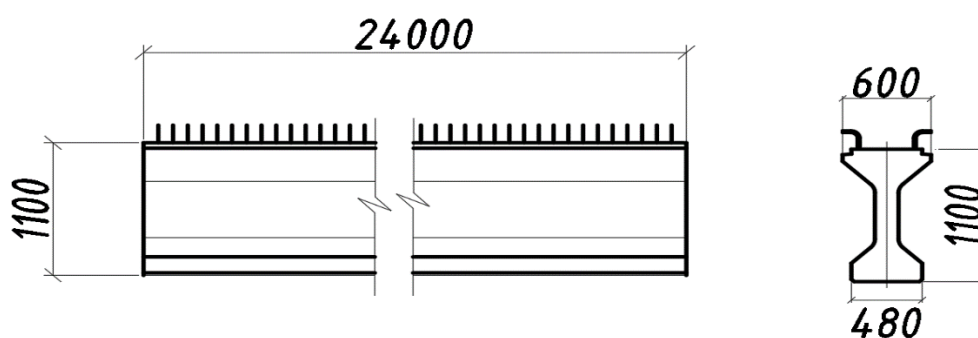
Попередньо напружена залізобетонна балка 24м
